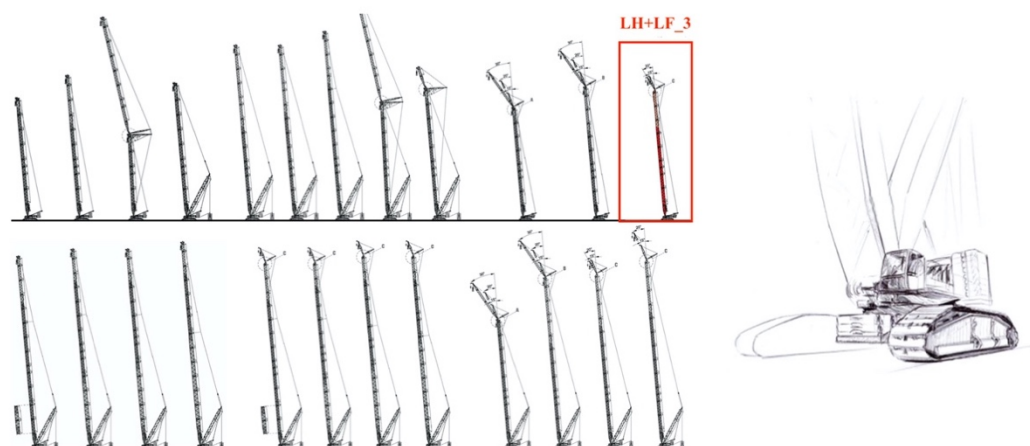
Ensemble des configurations d'équipement de la grue SL3280 et dessin d'une grue sur chenilles
